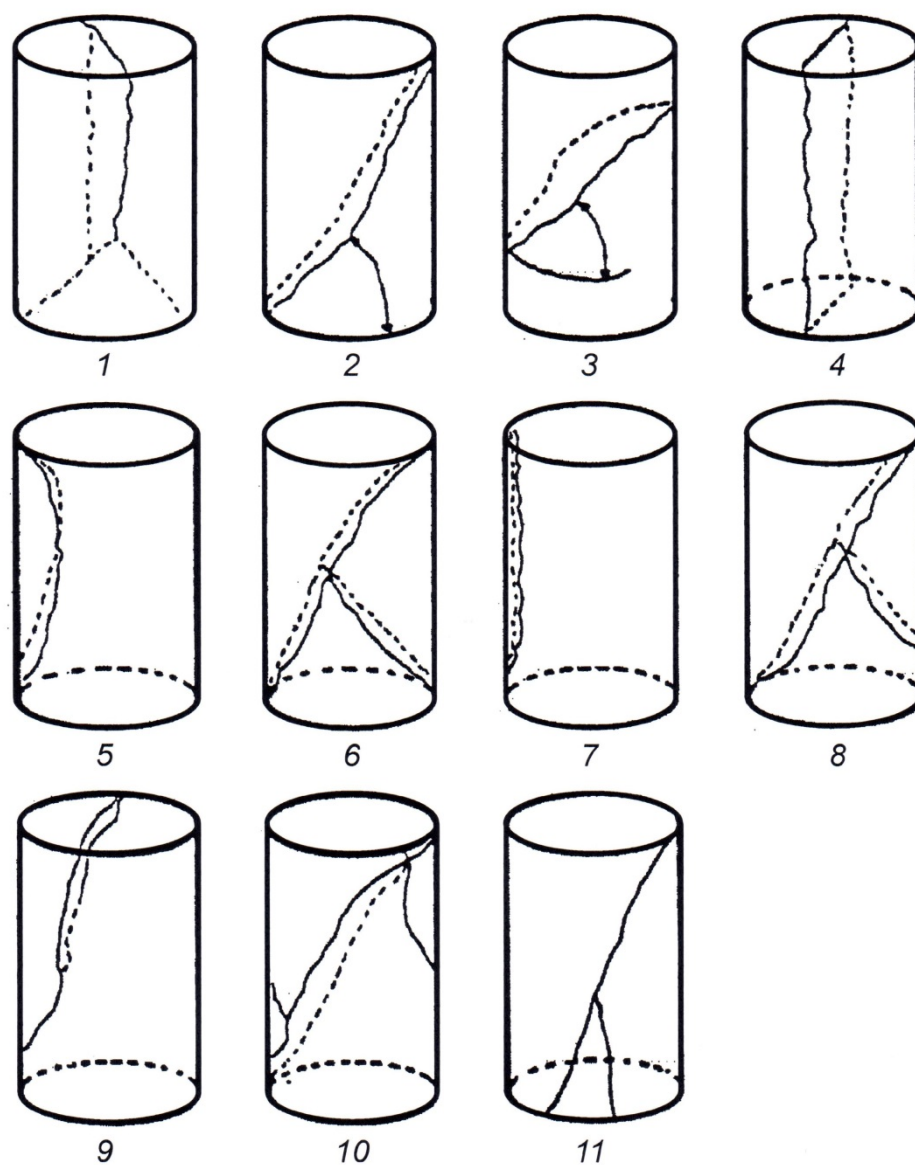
Примеры разрушений образцов-цилиндров при испытаниях на сжатие:
